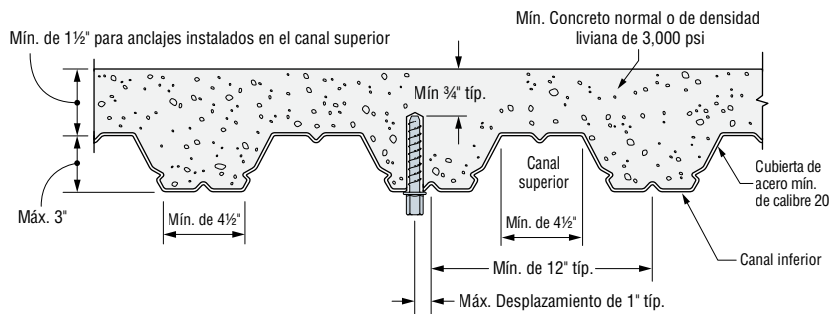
Instalación de THD50234RH en concreto sobre cubierta de acero
